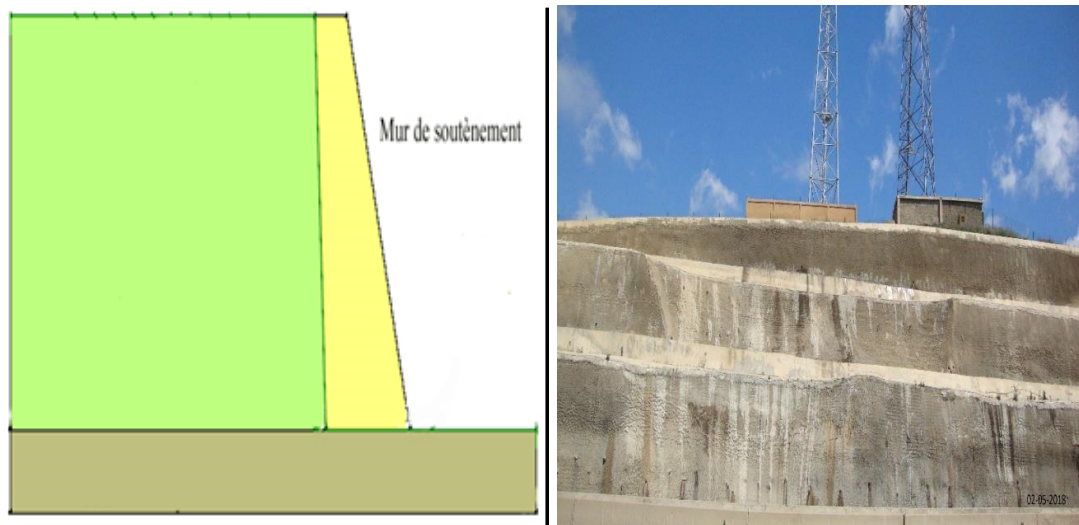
Mur de soutènement en béton armé (Autoroute Est-Ouest).
